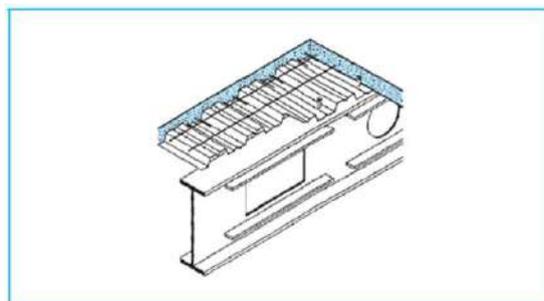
Dalle mixte connectée à une poutrelle à âme ajourée
